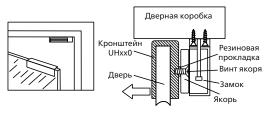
Монтаж на стеклянную дверь с помощью кронштейна U типа (UHxx0).
